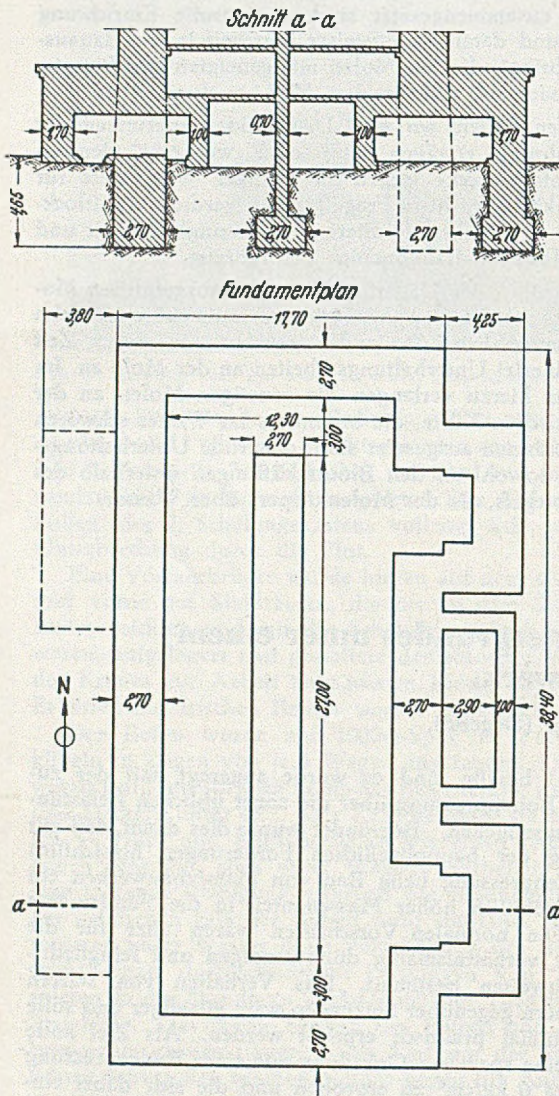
Querschnitt und Fundamentplan des Bauwerkes.
